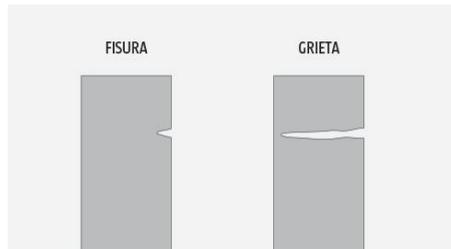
Fisura y grieta. Fuente Wikipedia.
